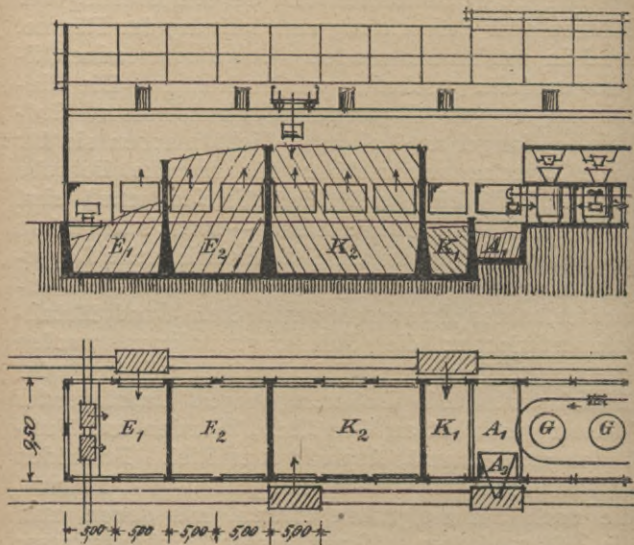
und 47. Lagergrube der Westfäl. Stahlwerke, Bochum.
